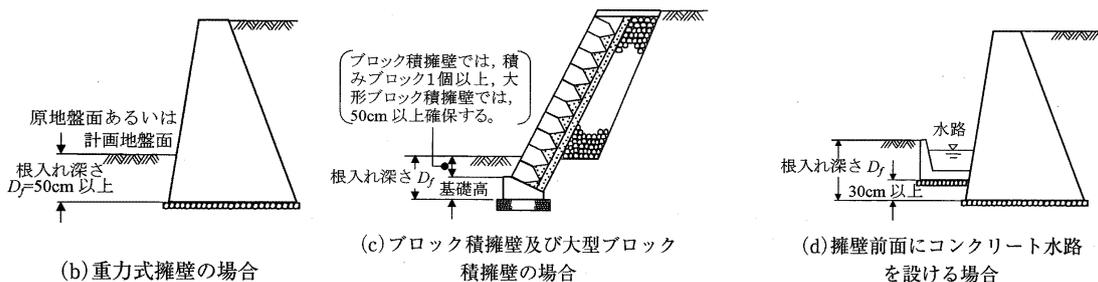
擁壁工の直接基礎の根入れ深さ (出典：擁壁工指針p.129)
